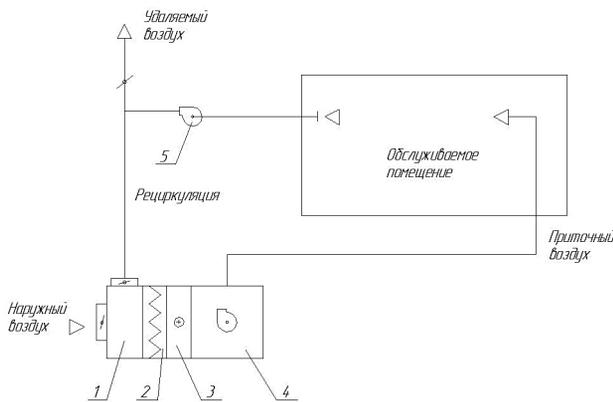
Система вентиляции с рециркуляцией: 1 — приемная секция; 2 — воздушный фильтр грубой очистки; 3 — воздушонагреватель; 4 — приточный вентилятор; 5 — вытяжной вентилятор
